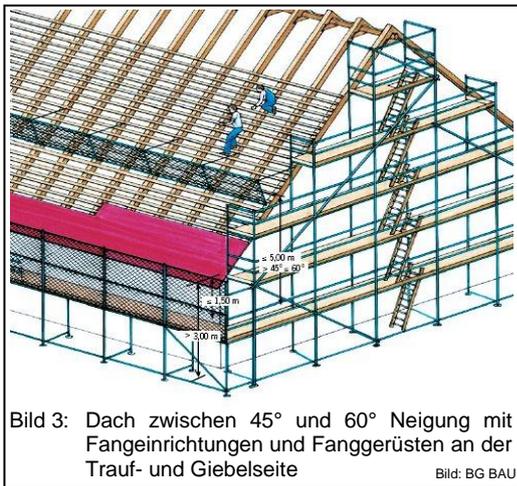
Dach zwischen 45° und 60° Neigung mit Fanggerüsten und Fangeinrichtungen an der Trauf- und Giebelseite
